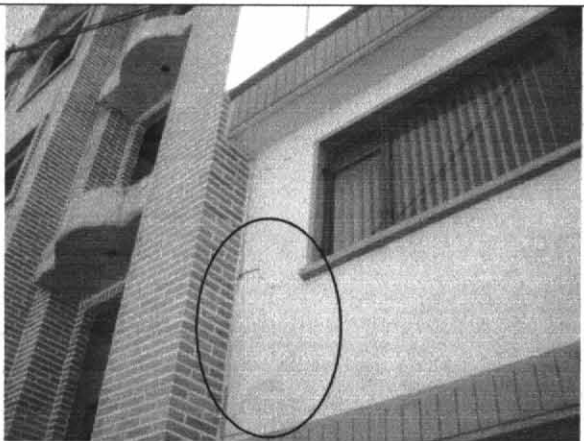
Fisuras en la fachada del 2º piso.
